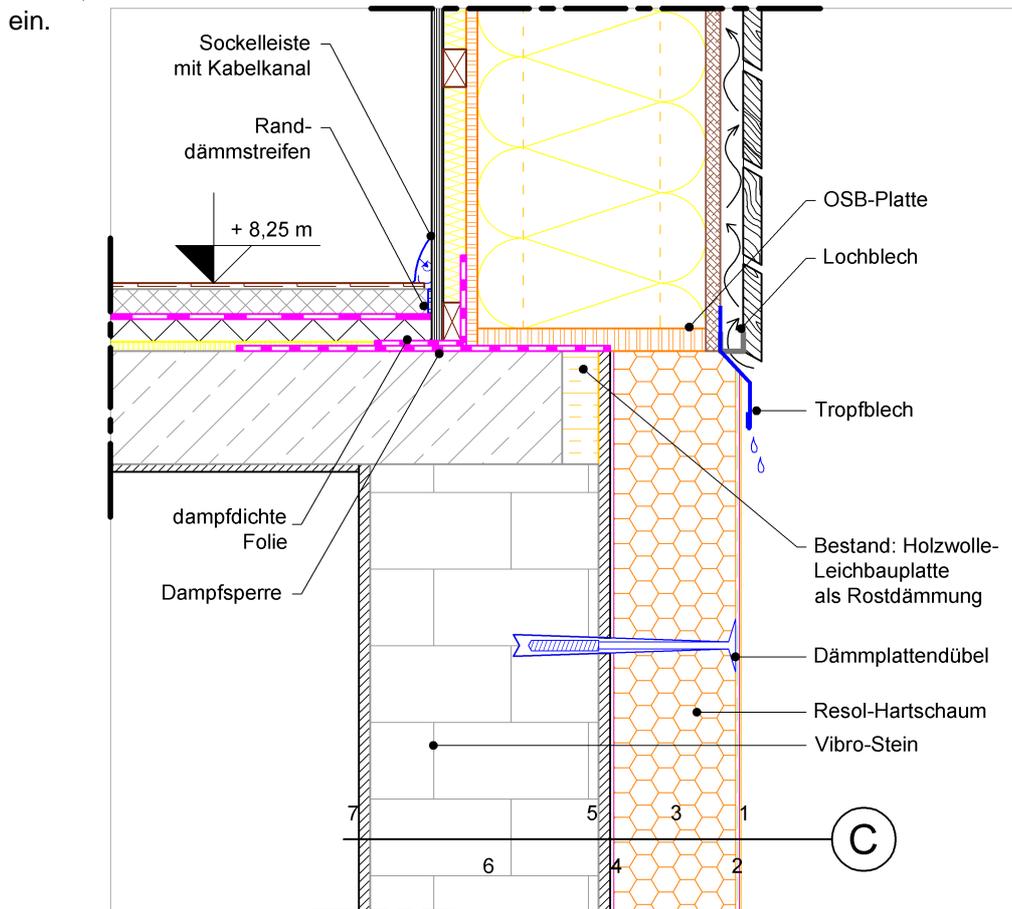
Detail C Außenwand, Sanierungsvariante *Passivhaus mit Dachgeschoß
